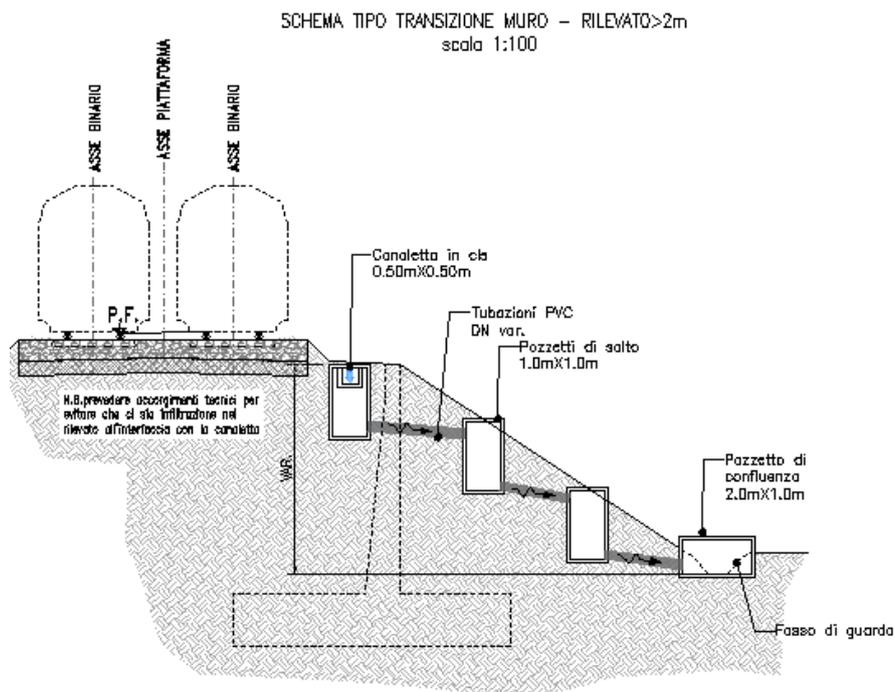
Sezione tipo transizione canaletta-fosso di guardia
